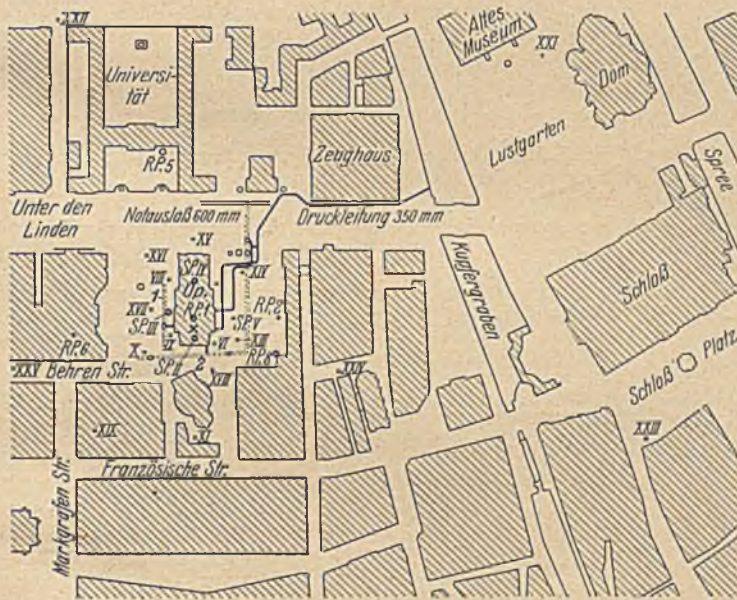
Lageplan der Umgebung der Baustelle mit Darstellung der Einrichtungen zur Beseitigung der gepumpten Wassermenge.
